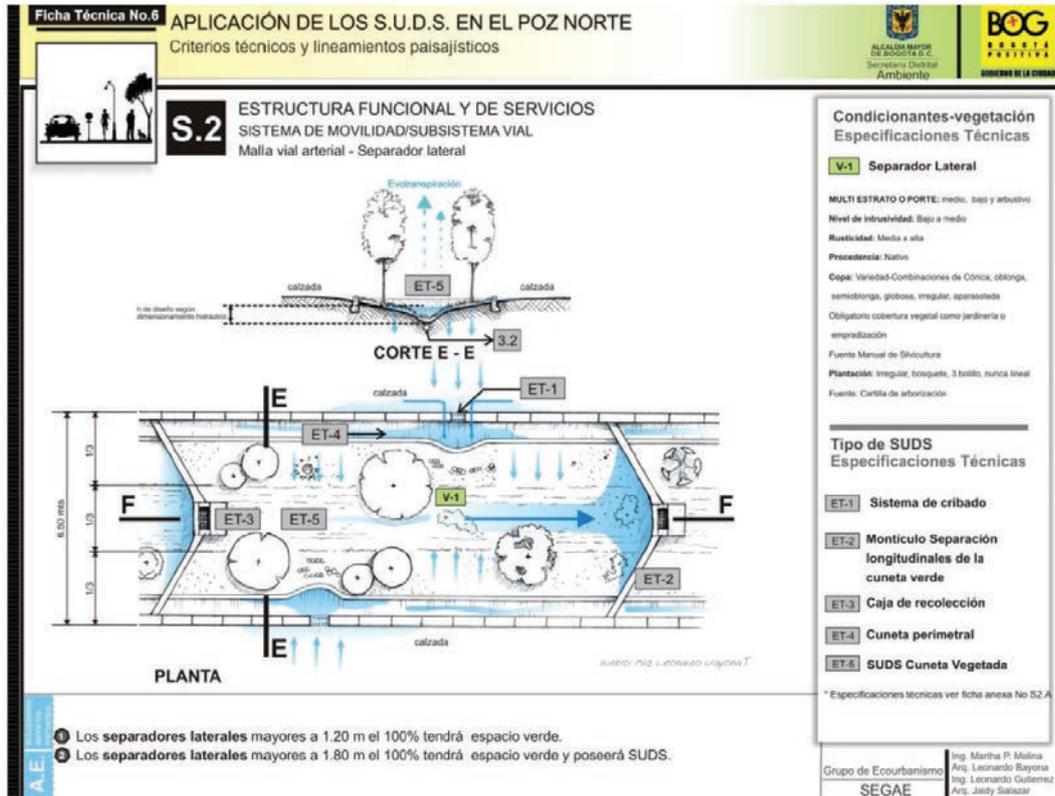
Aplicación de los S.U.D.S. Planta separador lateral.
